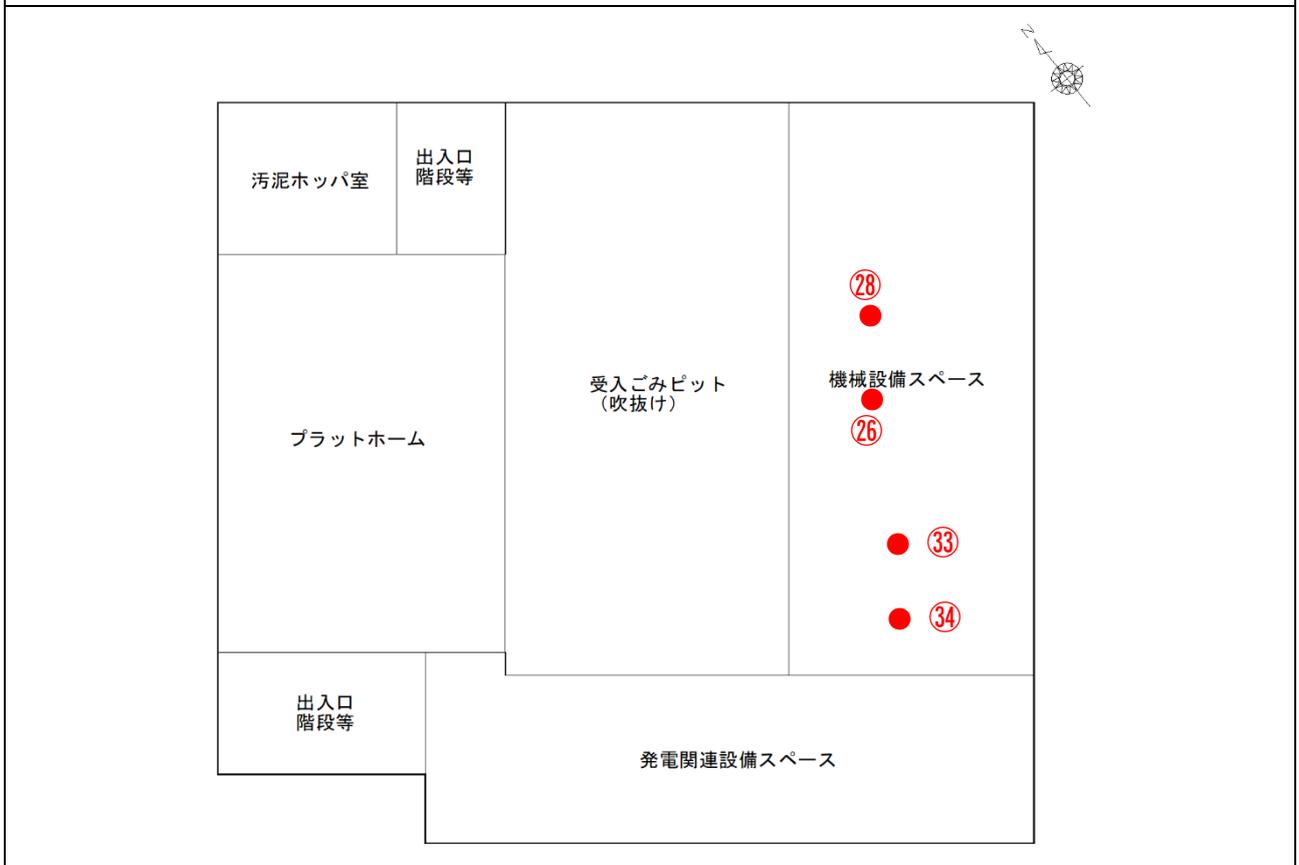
(2) 廃棄物受入棟平面図 (1階)
